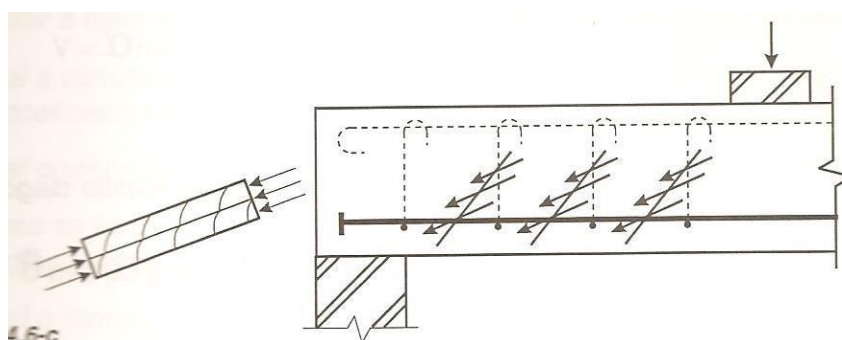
Tensões de compressão atravessando diagonalmente as fissuras
